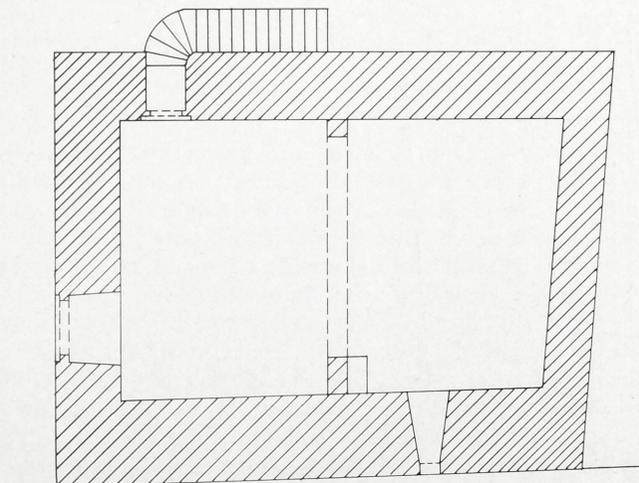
Grundriß des Urbaus (Arkensches Burghaus) – Keller-geschoß
